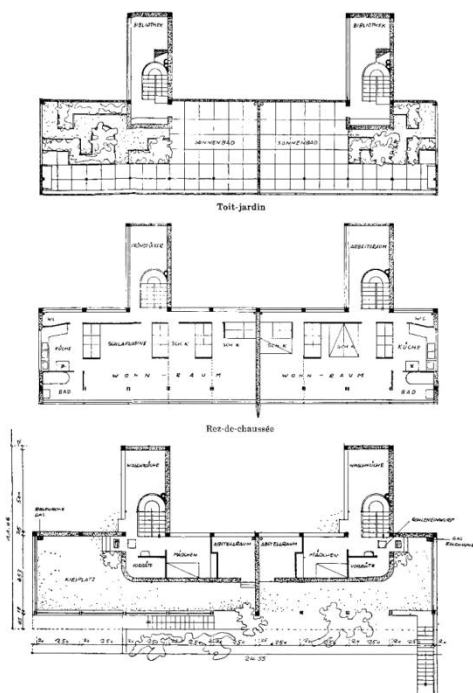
De abajo a arriba: planta baja, planta primera (a la izquierda la vivienda por el día y a la derecha por la noche) y planta de cubiertas del bloque de Le Corbusier en la Weissenhof Siedlung. (W. Boesiger, 2006)
